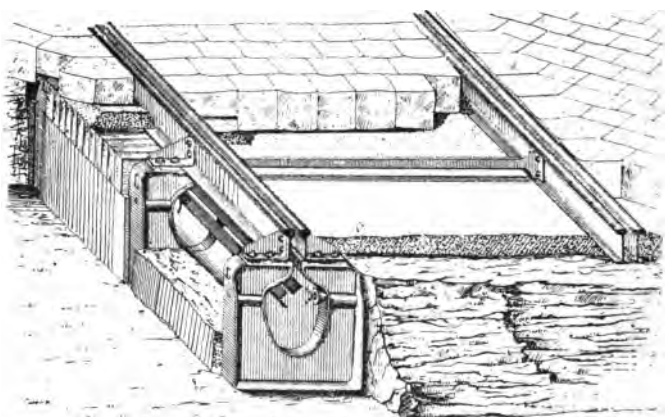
Caniveau de Budapest. — Coupe en voie courante.
